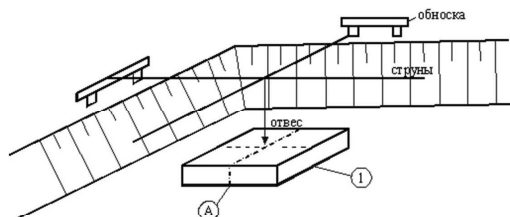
Схема укладки блоков с помощью струн и отвеса
